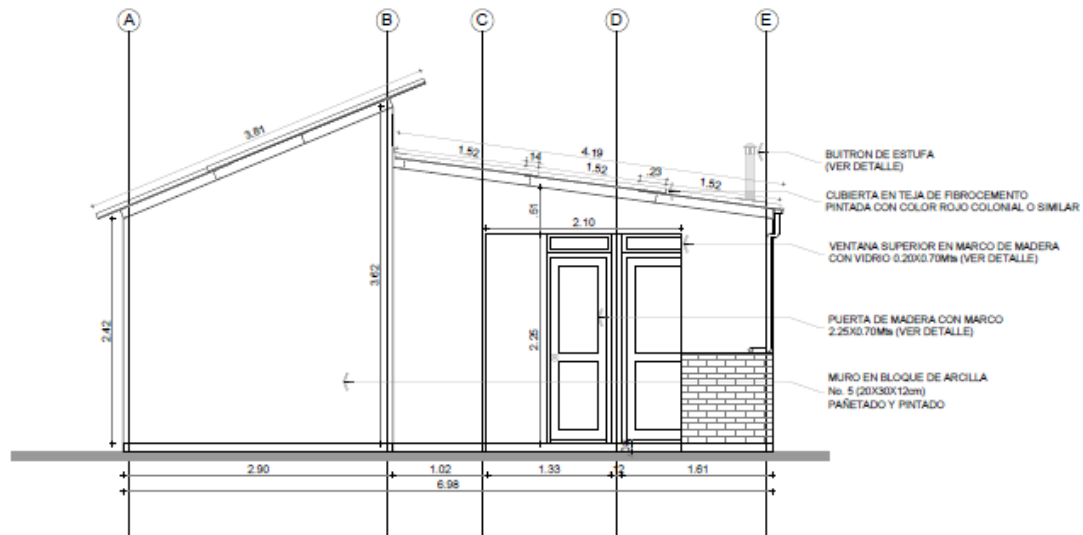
Plano de fachada VISR Proyecto Tipo SV-HT-001
